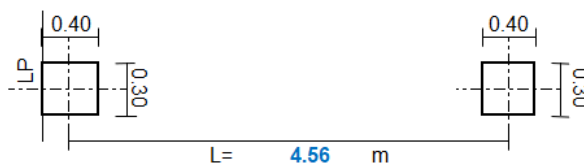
Diseño de Zapatas y Viga de conexión (Final)
